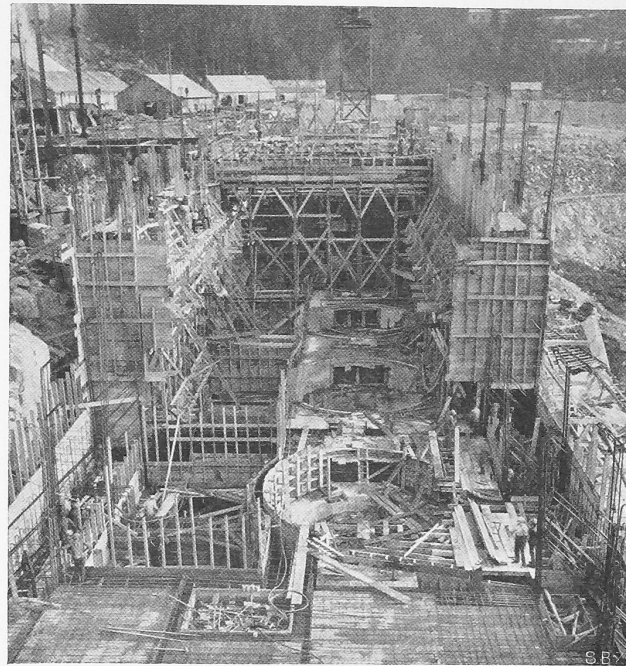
Blick in die Baugrube des Maschinenhauses.
